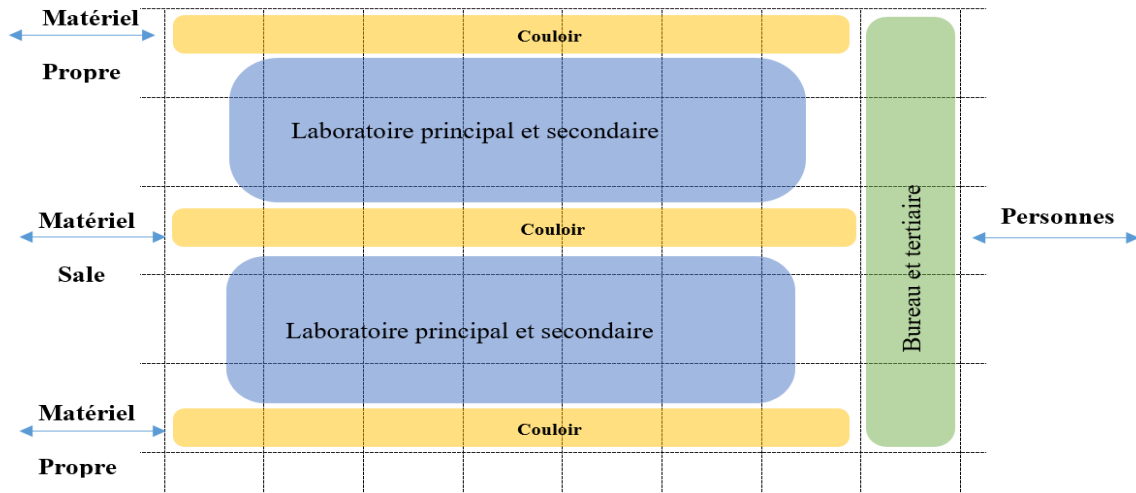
c) Disposition du plan illustrant la disposition à trois couloirs. Cette disposition offre la plus grande opportunité. (Pamela Buxton / 2018)
